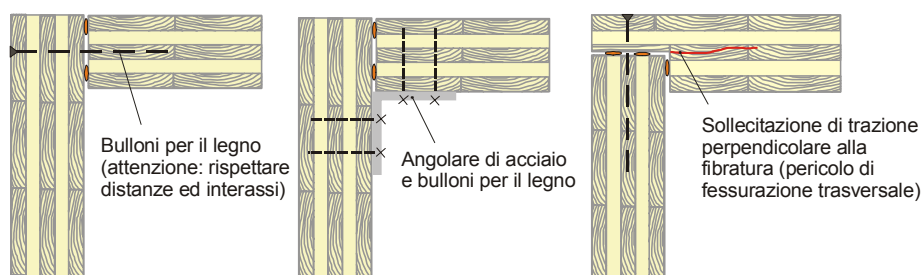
Giunzione parete-parete, possibilità di realizzazione del collegamento d'angolo mediante bullonatura
